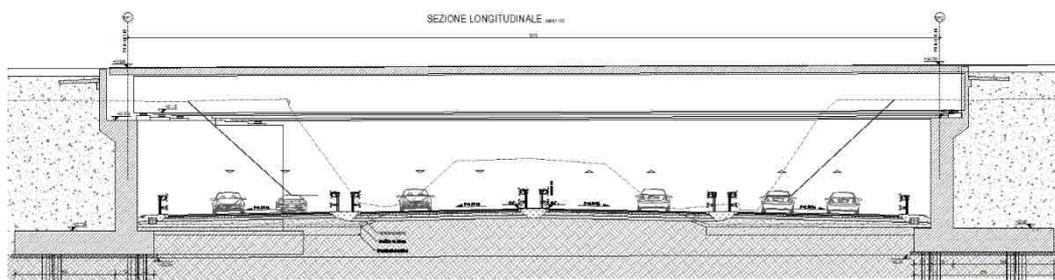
Sezione longitudinale impalcato – Cavalcavia svincolo SS.131dir
